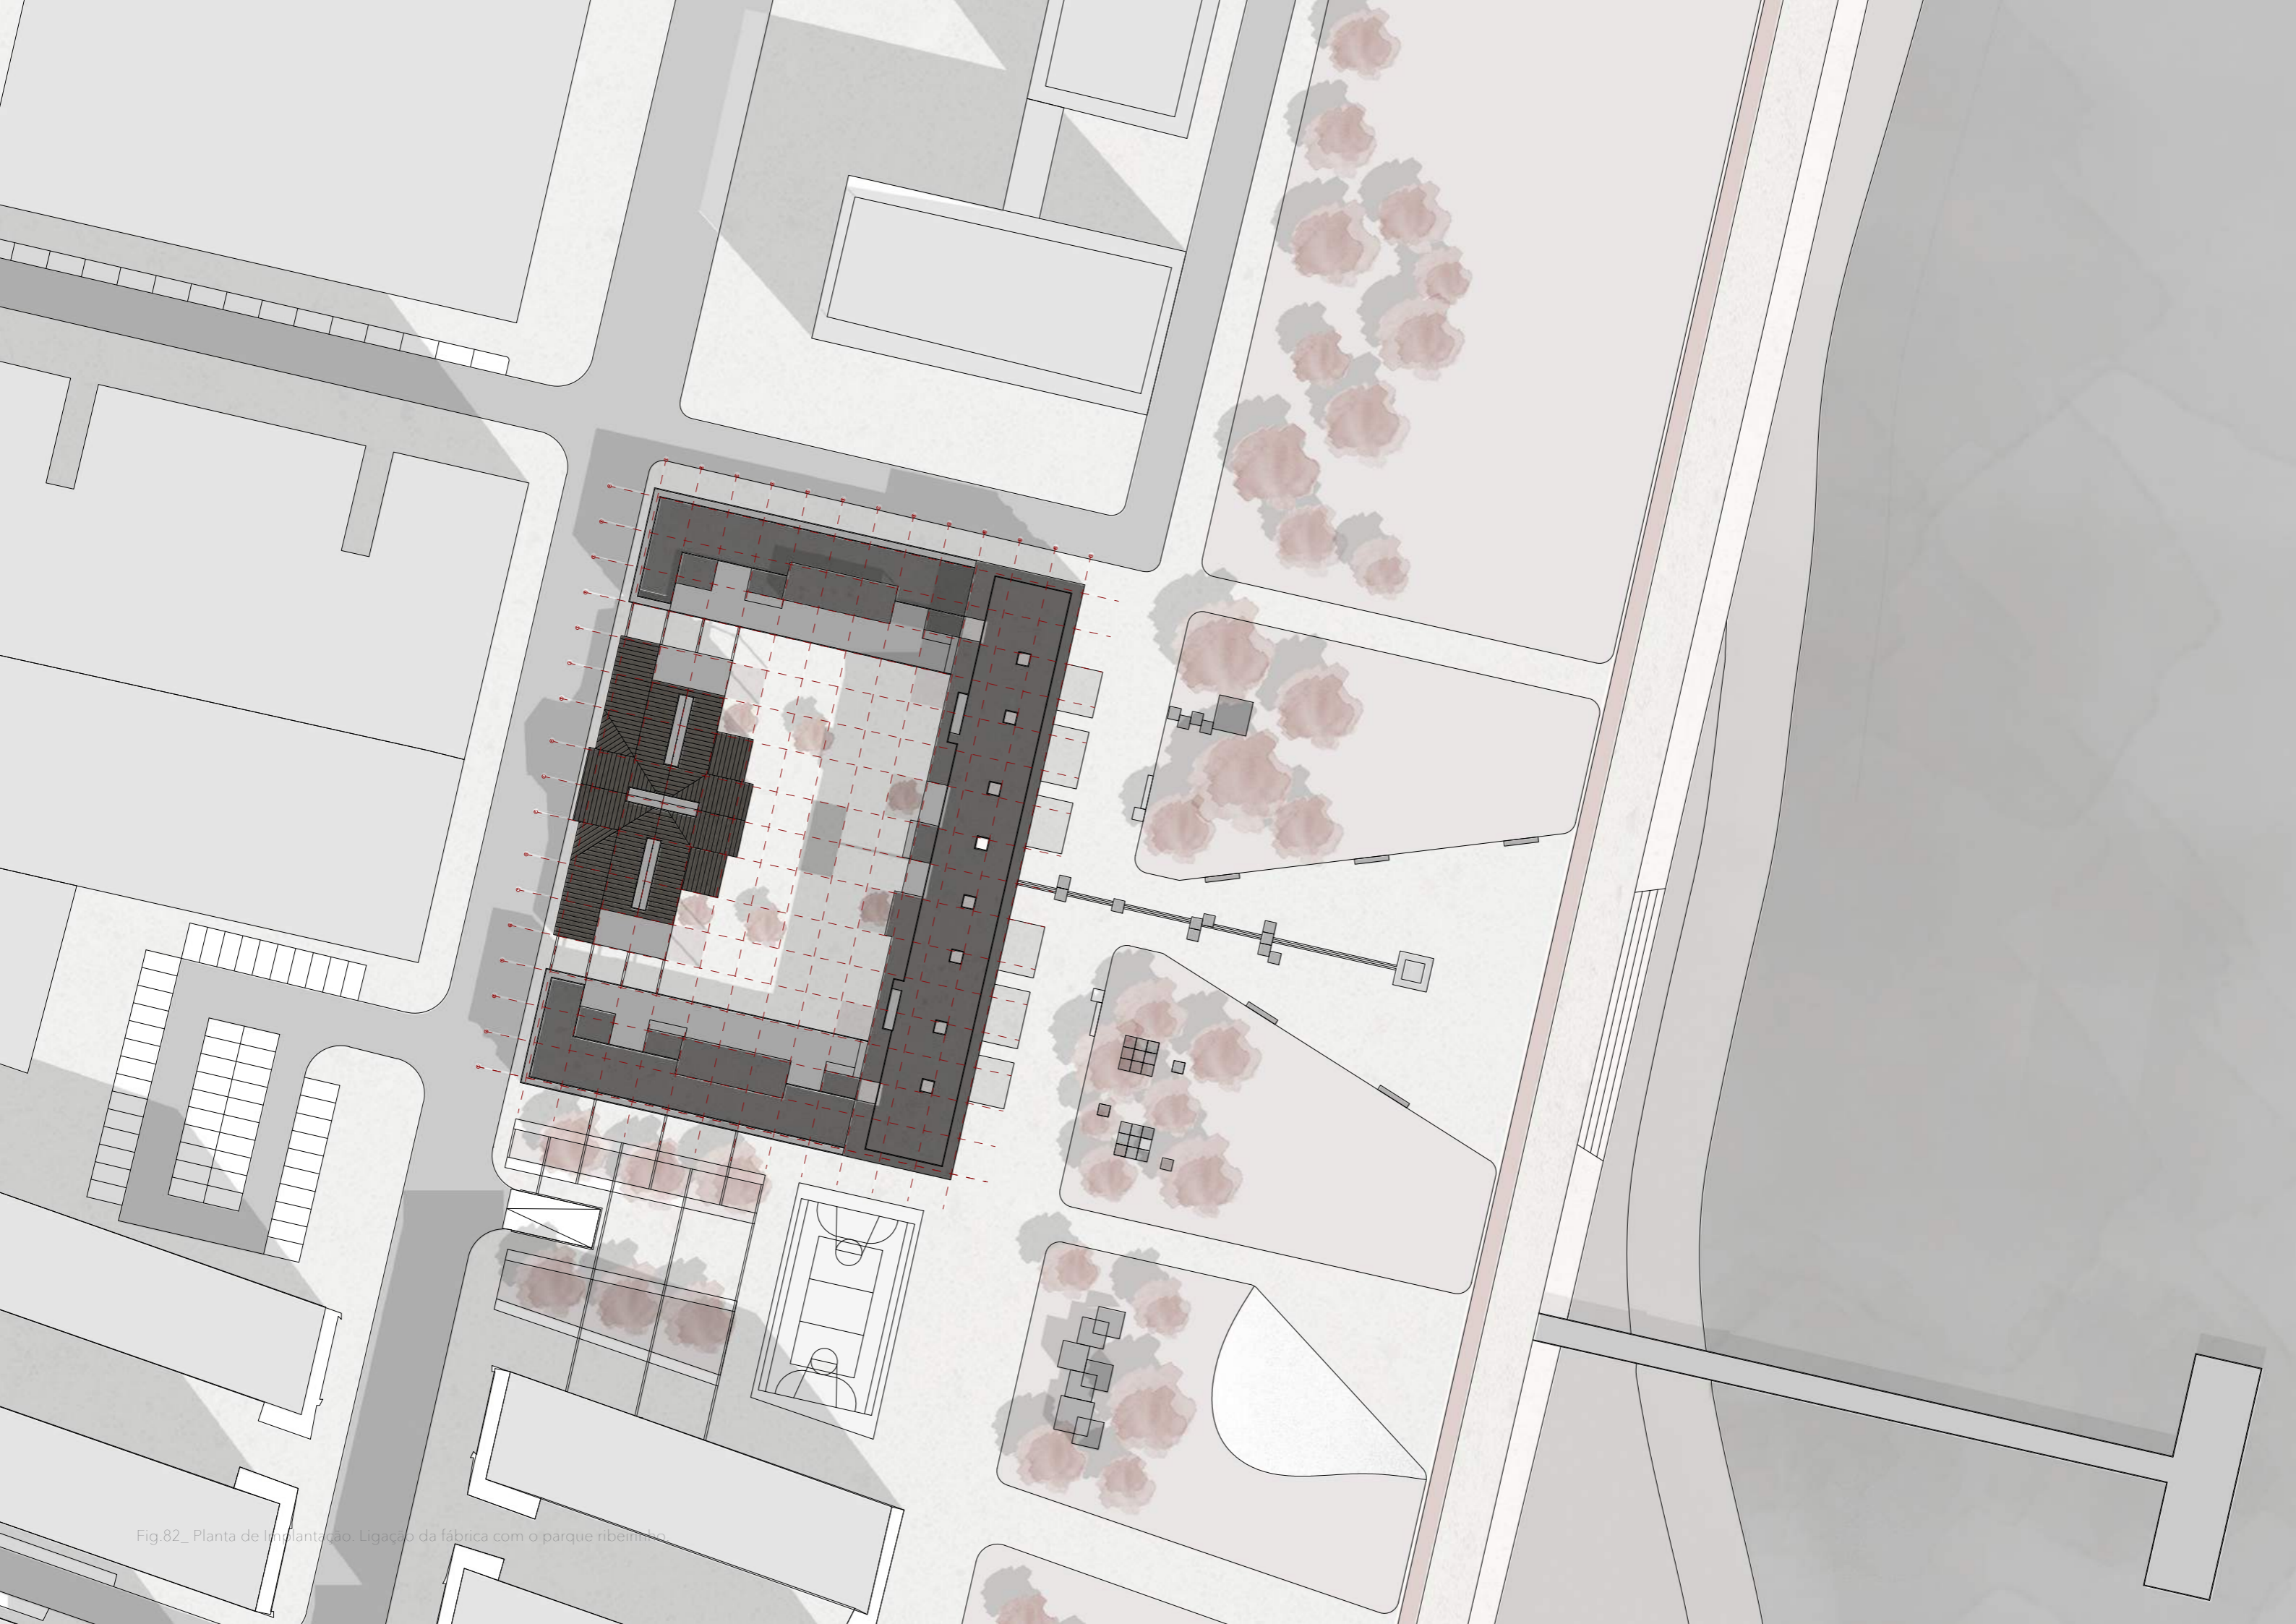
\_ Planta de Implantação. Ligação da fábrica com o parque ribeirinho.
